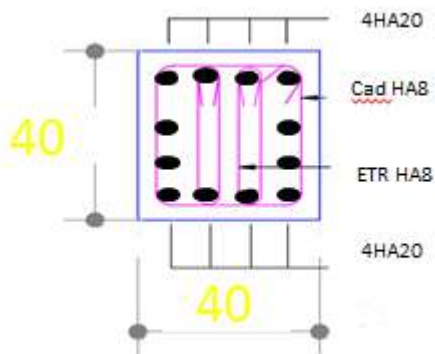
Ferrailage des poteaux de 4ème et 3ème étage.
